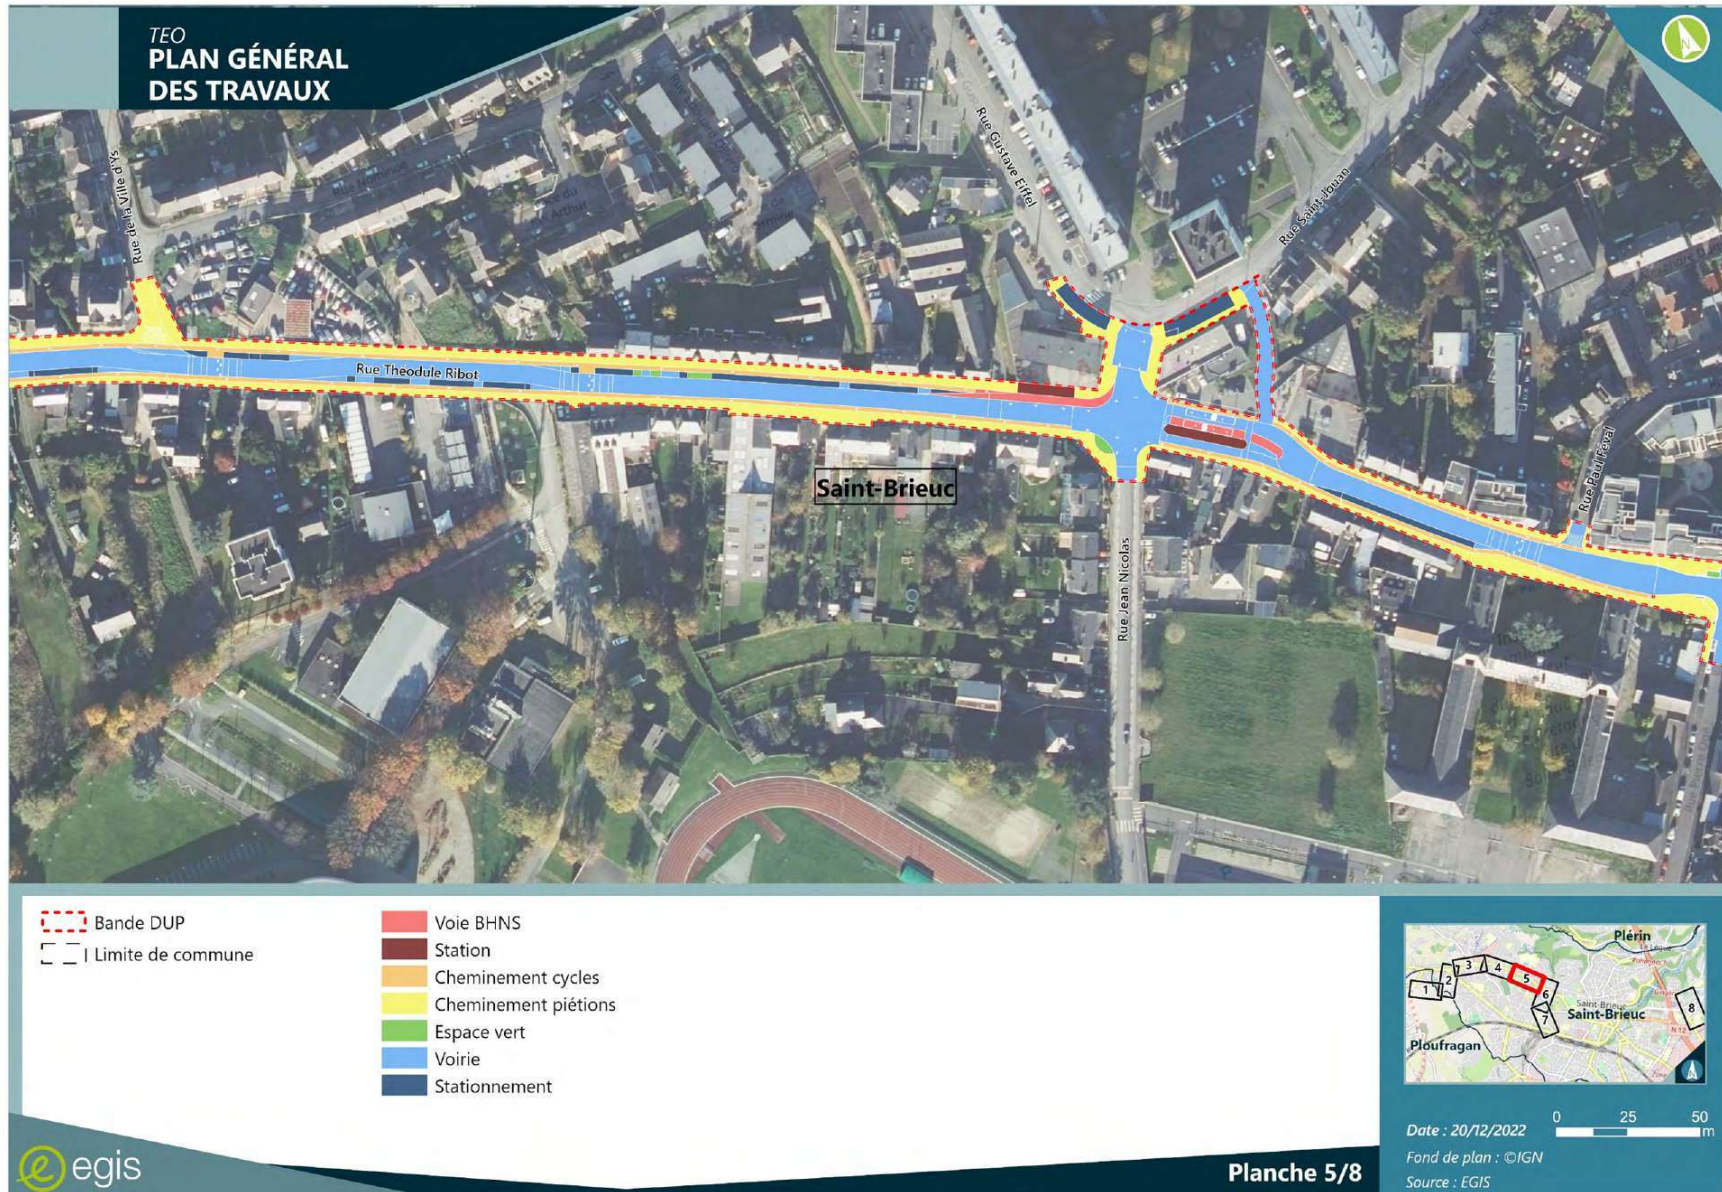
Plan général des travaux 5/8 (Source : EGIS)
